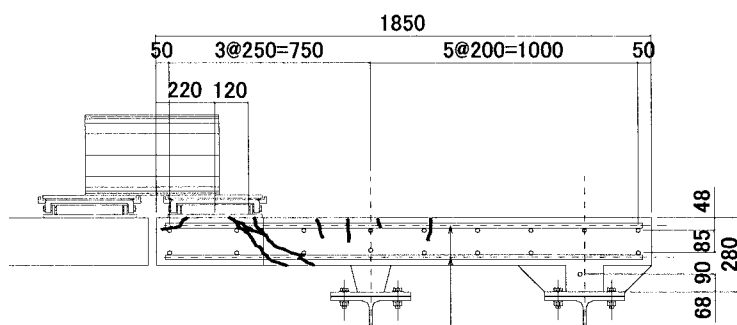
切断面のひび割れ状況 (W 床版, A-A 断面)
